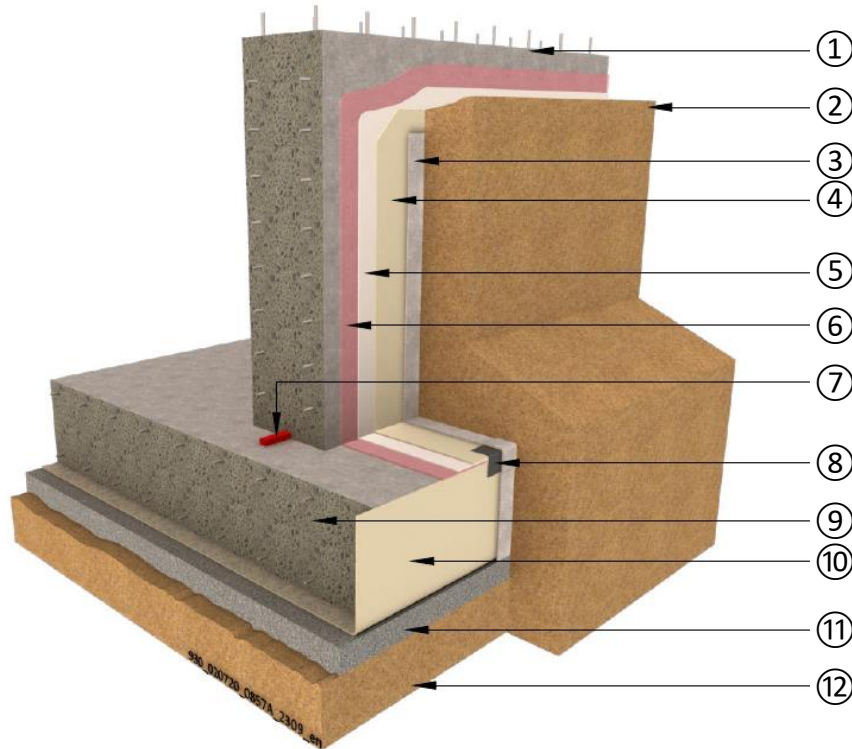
DETAILS - ÜBERGANG BODENPLATTE ZUR WAND
